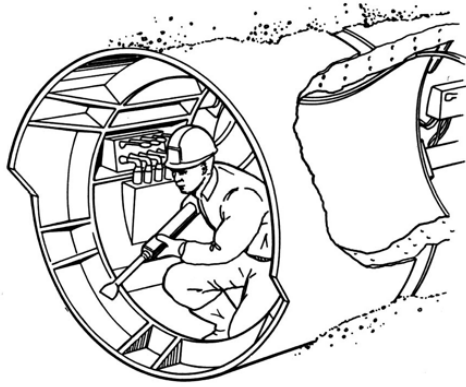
Oppsettet ved mikrotunneling (Sterling, 2018)
